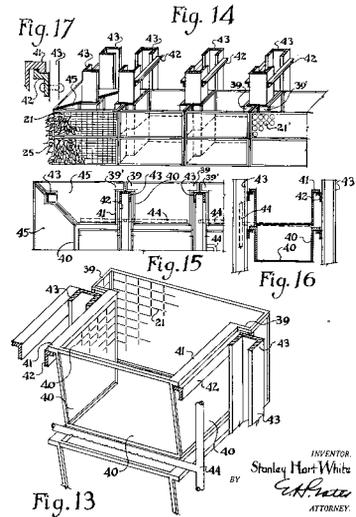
Plano de detalle de los componentes vistos en la Fig. 14.
